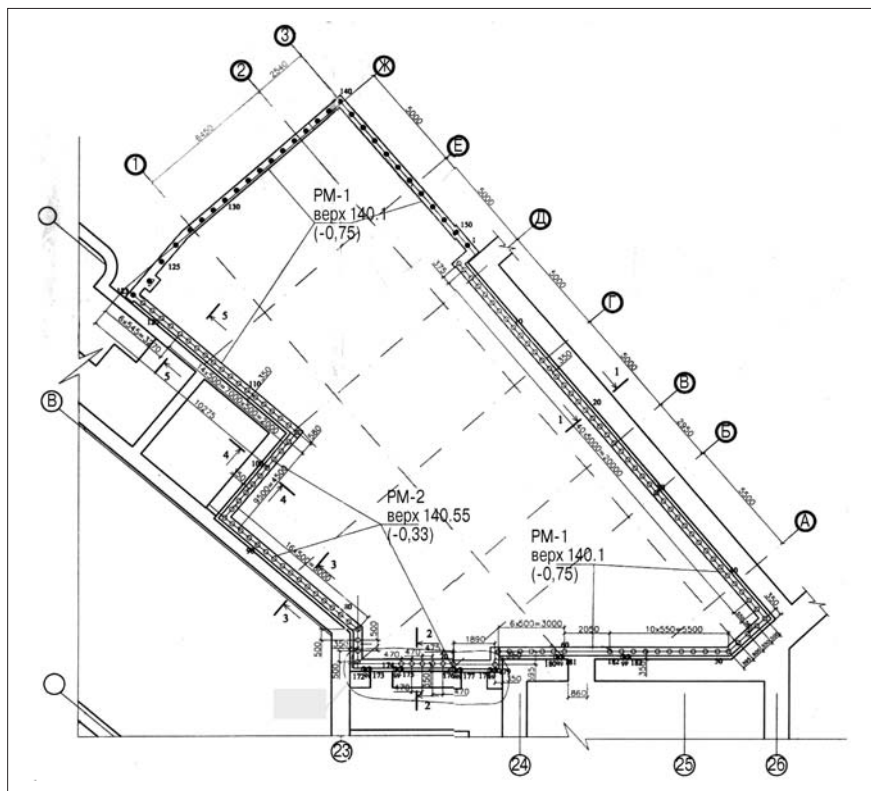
План шпунтового ограждения и распределительной железобетонной балки
